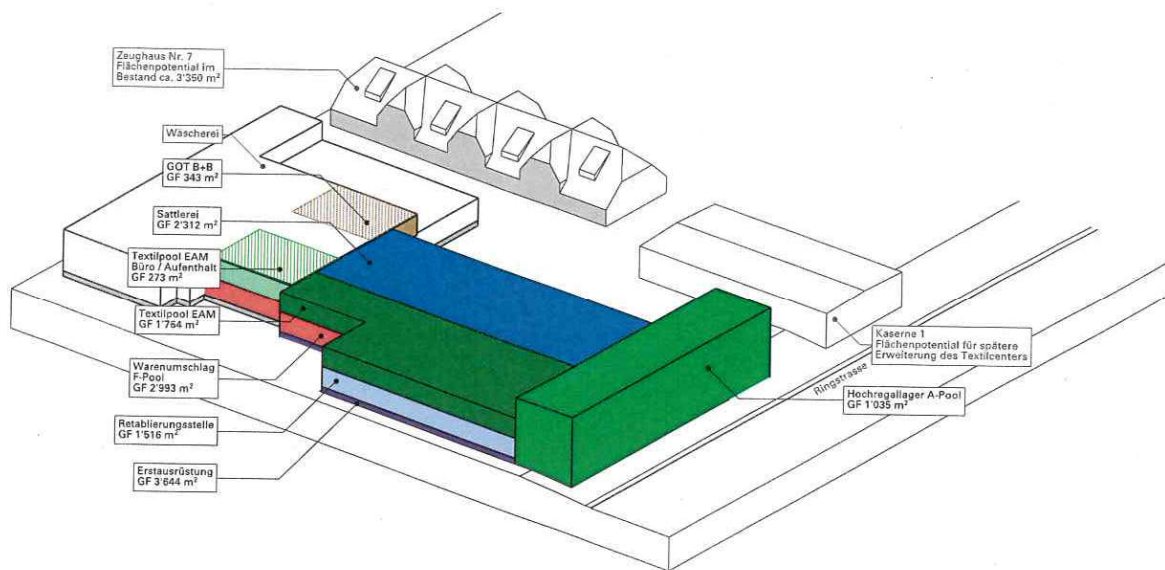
Anbau an Wäscherei mit automatischem Hochregallager
